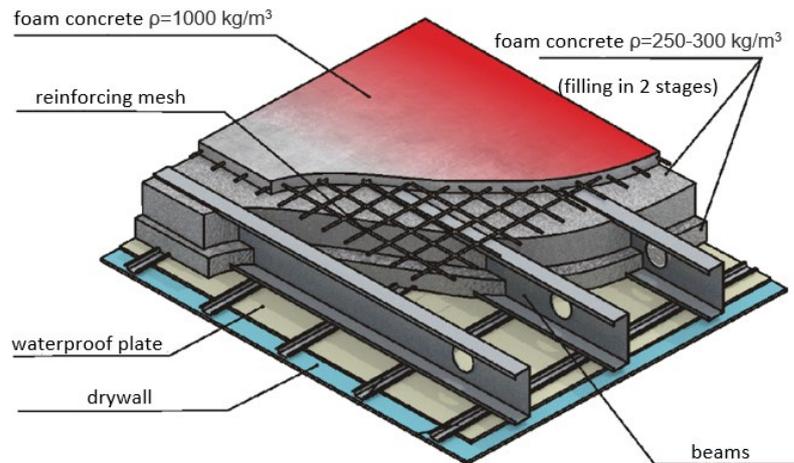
Конструкция перекрытия с жестким диском из конструкционного пенобетона [73]
